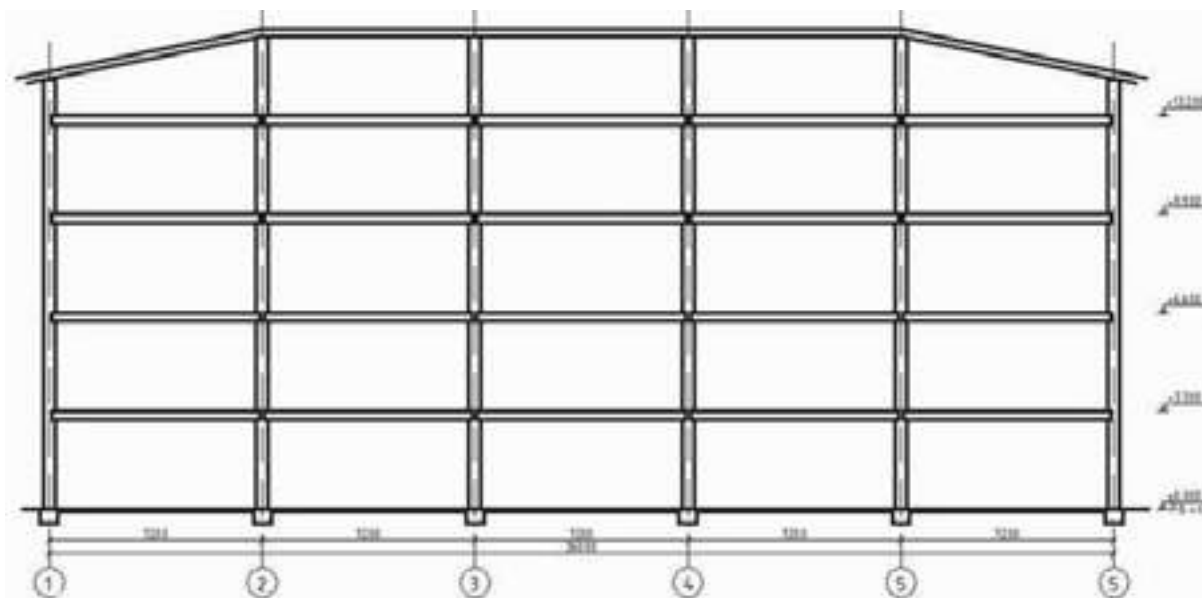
Повздовжній розріз 4-поверхового будинку
